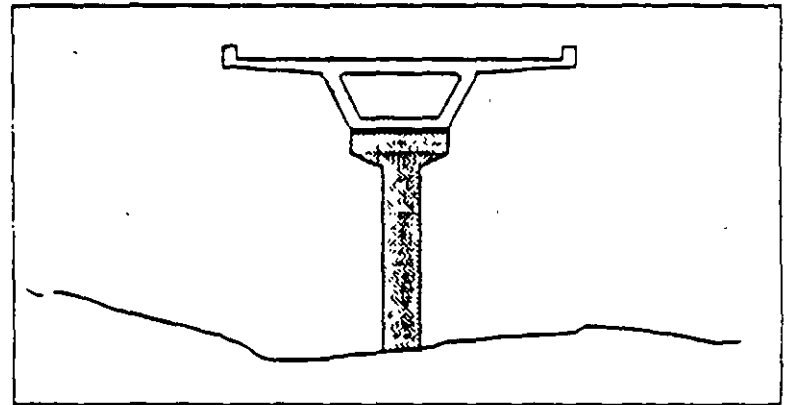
Pila, tipo 30, Columna sola con cabezal
